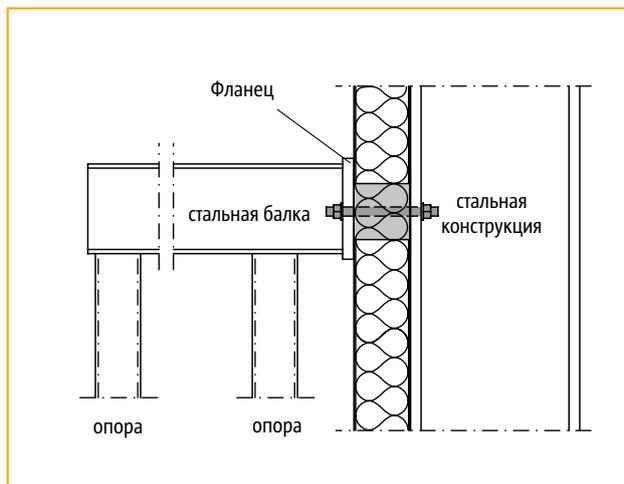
Schöck Isokorb® модуль KST-QST для стальных конструкций на опорах
